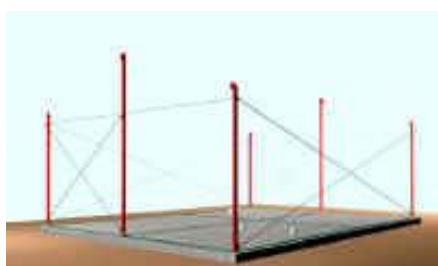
Início da montagem da estrutura, pilares parafusados na fundação *radier
